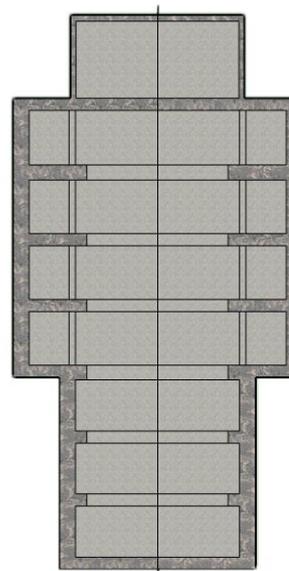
Interpretación planta Iglesia Catí en 1678
